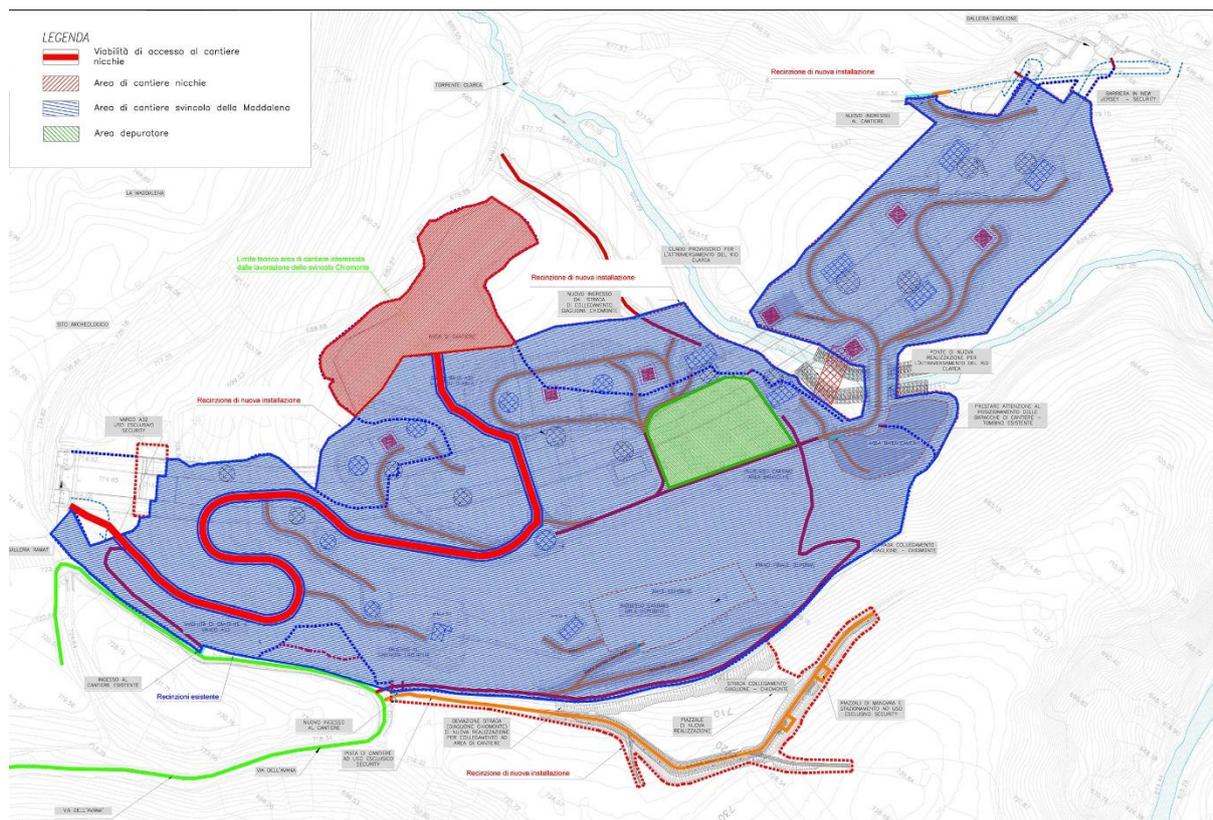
Perimetrazione delle aree del cantiere nicchie, cantiere dello svincolo e impianto di depurazione
